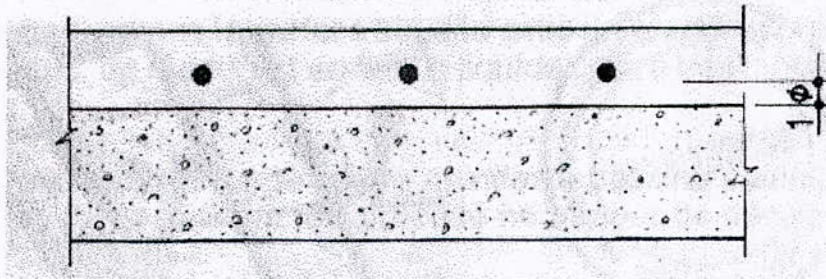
Armatures supplémentaires en surépaisseur de dalle
